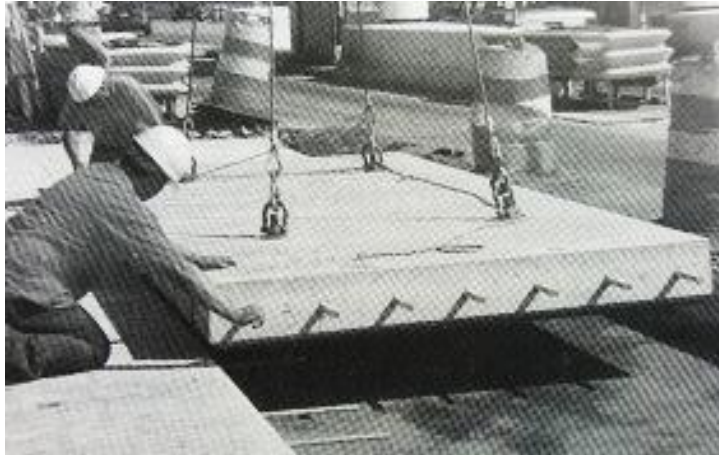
Pavimento de concreto com placas pré-moldadas
